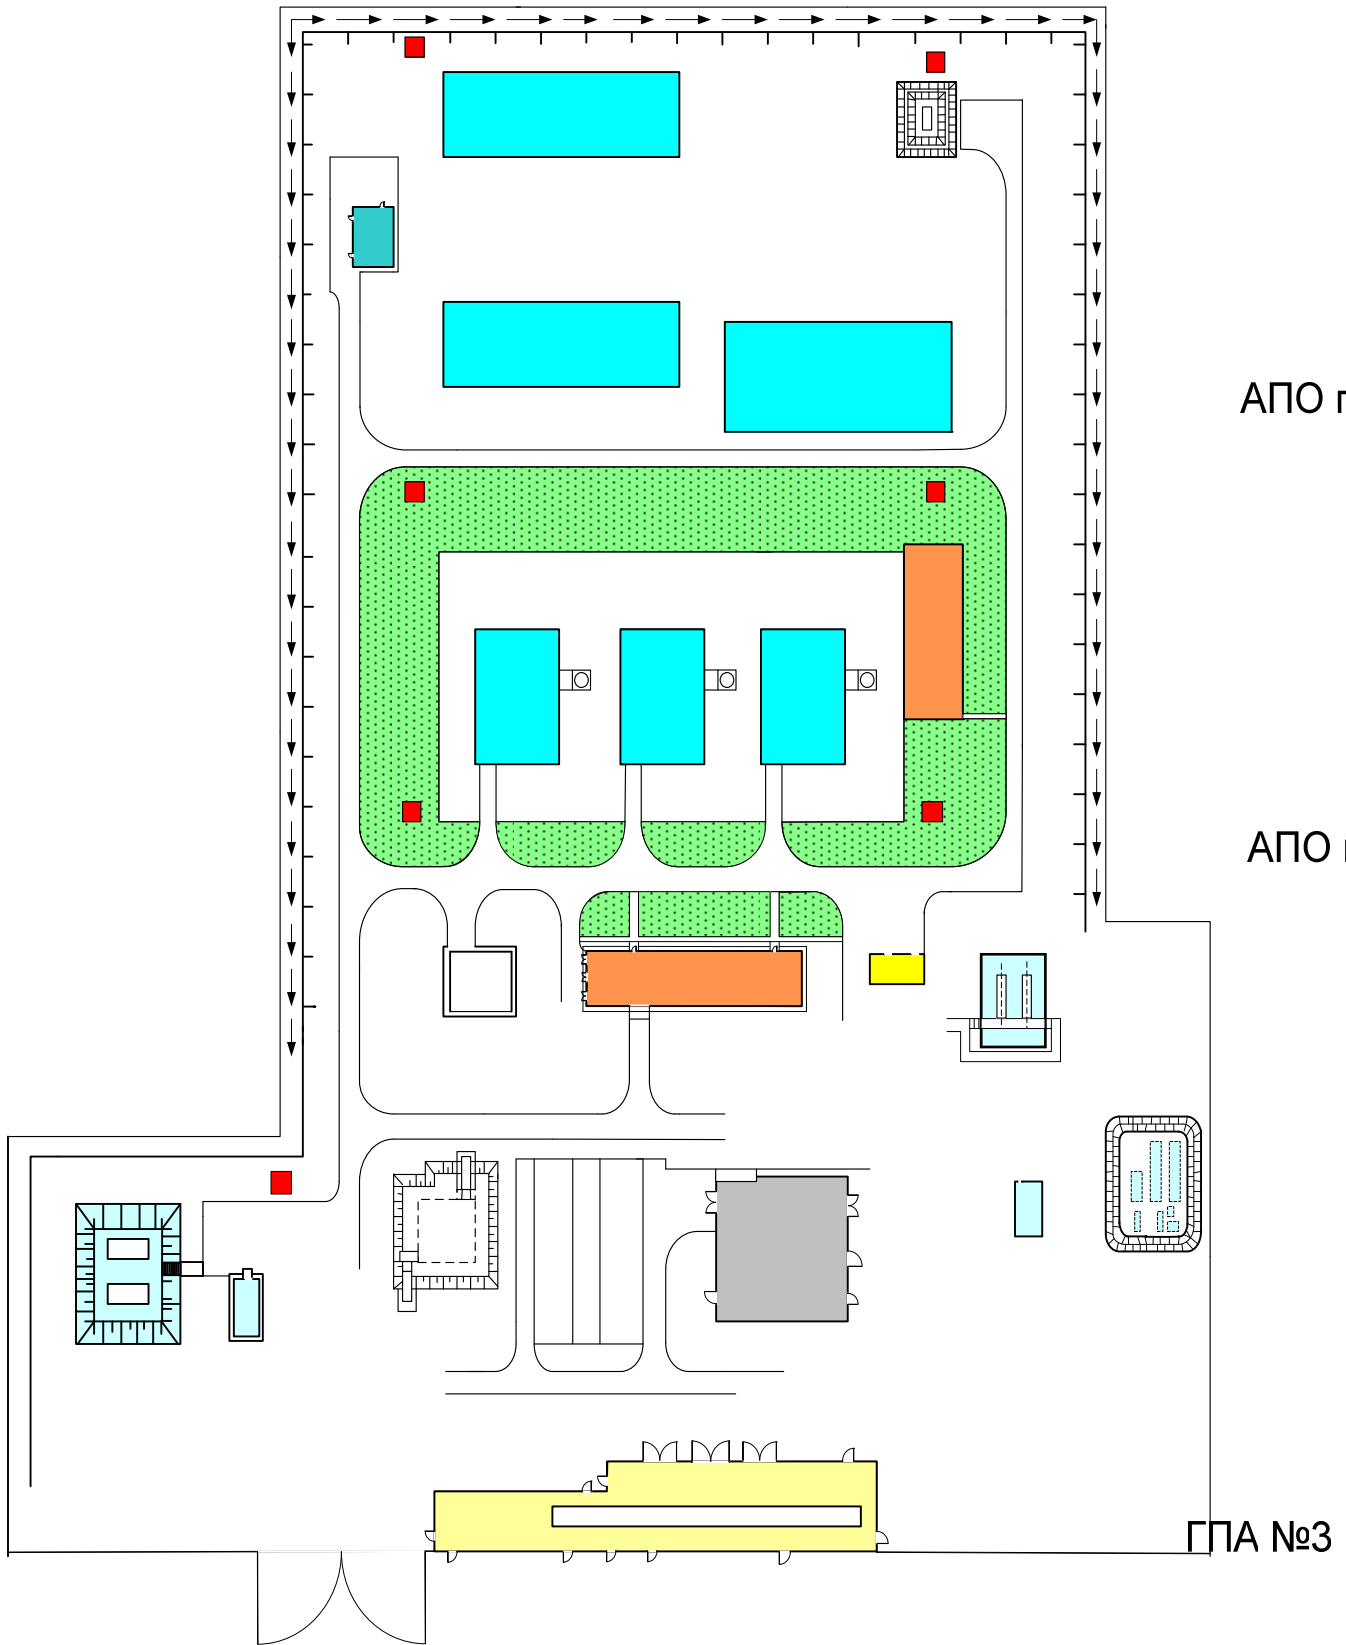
План будівель та установок Барського ЛВУМГ КС-37.
